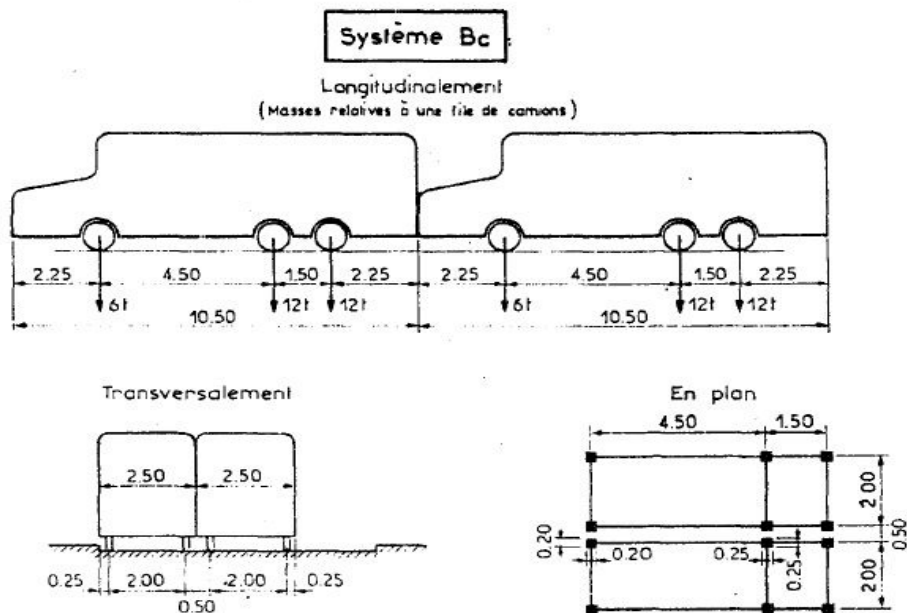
système Bc longitudinalement, transversalement et en plan
